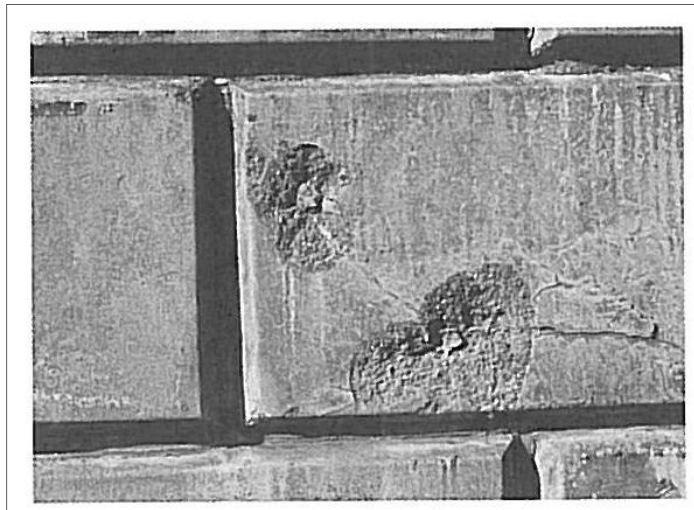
骨材中の泥分の影響によるひび割れ
